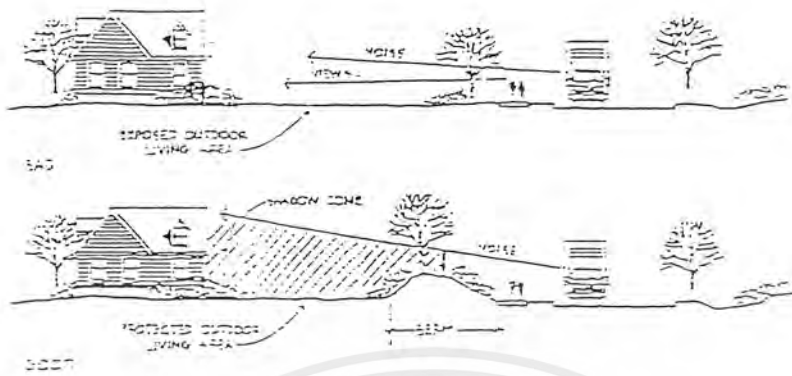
รูปแบบของผนังกันเสียง และผนังกันเสียงร่วมกับการพูนดิน
